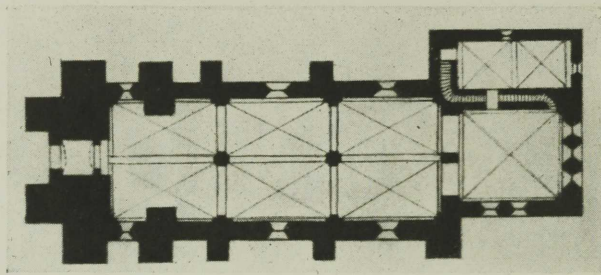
Grundriss der Kirche zu Kaarma. Nach Guleke.
